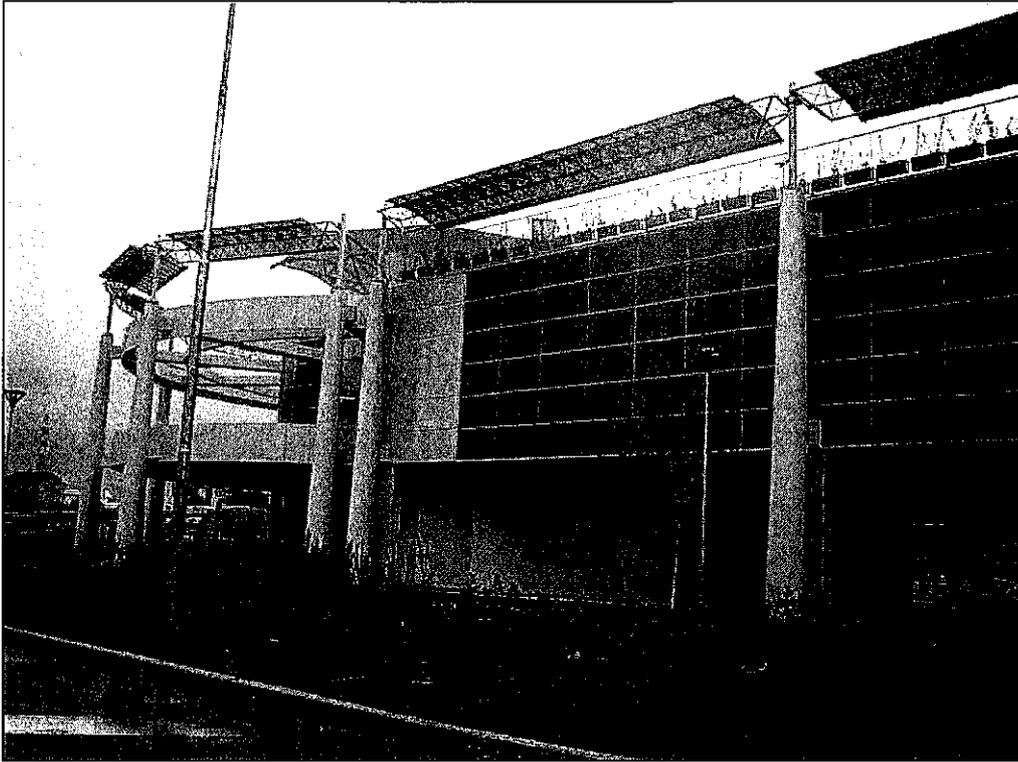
FOTO ESTERNA DELL'EDIFICIO – RAMPA E PIAZZA CIRCOLARE APERTA, PIANO PRIMO
